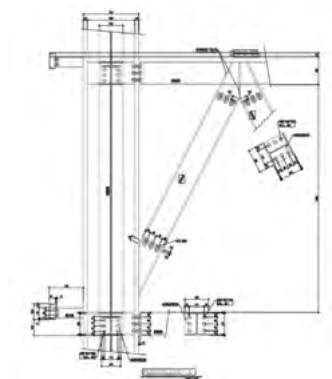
Pianta chiave, stralcio sezione tipica sul filo 1C e particolare dell'albergo
